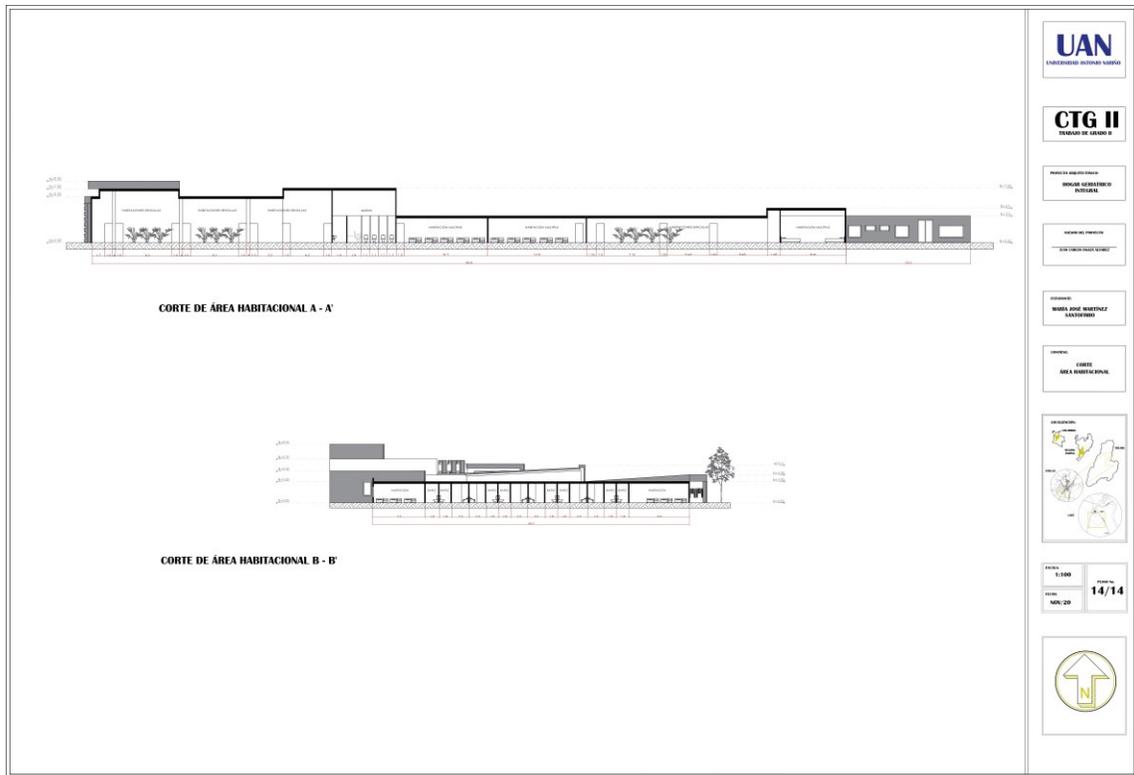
Planimetría cortes área habitacional. Fuente. Autoría Propia.
